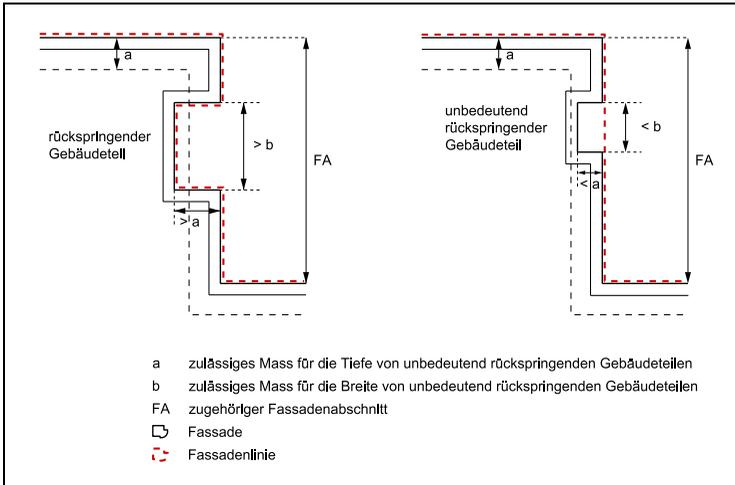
und 3.2 Fassadenflucht und Fassadenlinie (§§ 6, 6 a ABV)
